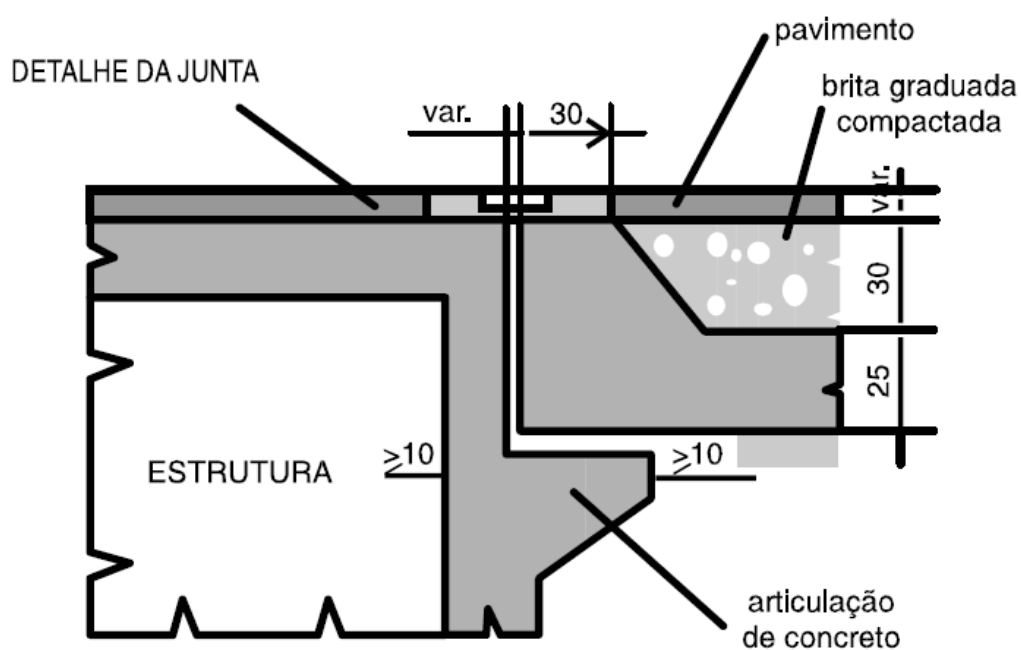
Apoio da laje de transição sobre a estrutura (DNER,1996)
